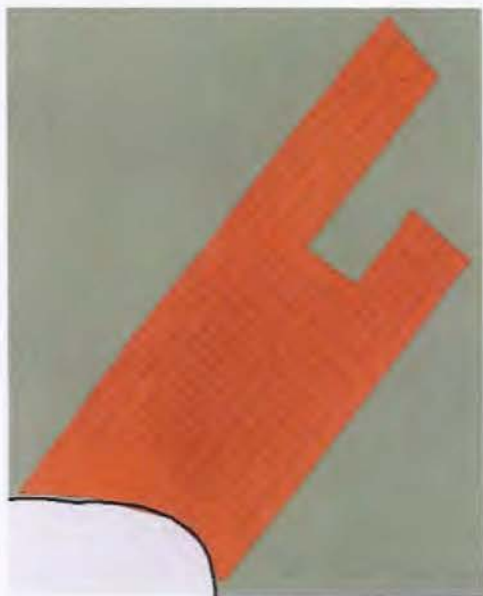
Distribución del condominio Montecarlo ubicado en el distrito de San Rafael Abajo. Fuente: elaboración propia.
